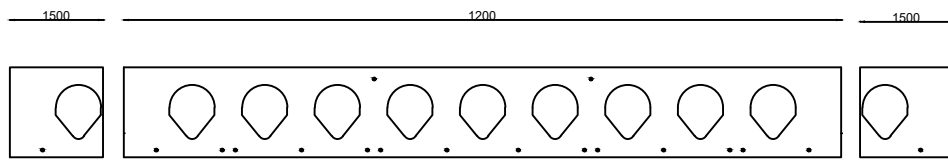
DETAIL PEMASANGAN SEGMENT PLAT P1 LT. 20-24
